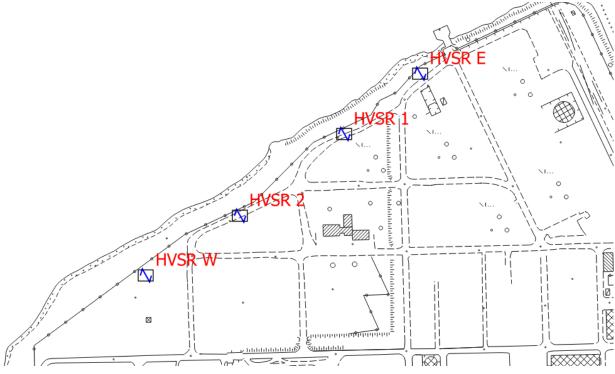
Estratto planimetrico non in scala riportante l'ubicazione delle prove HVSR eseguite.
